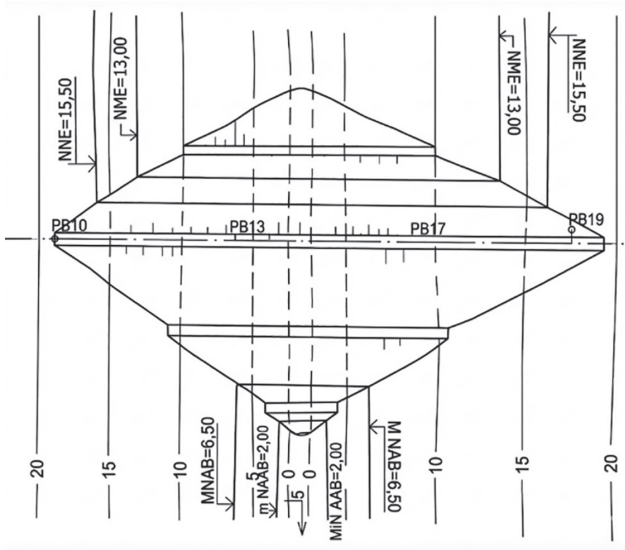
Esquema en planta de los principales elementos para implantar la sección transversal de una presa de tierra.
